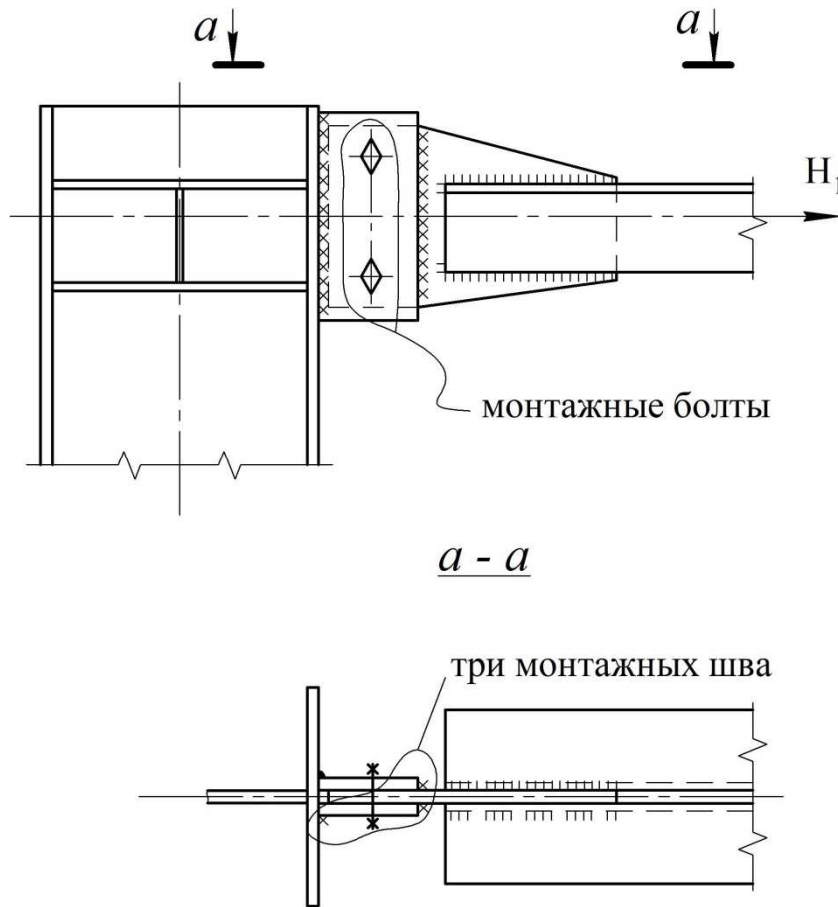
Вариант жесткого крепления верхнего пояса ригеля к колонне через накладку
